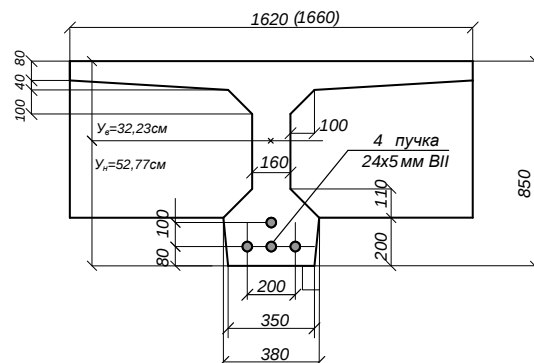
Поперечний переріз балок прогонової будови довжиною 14,06 м
